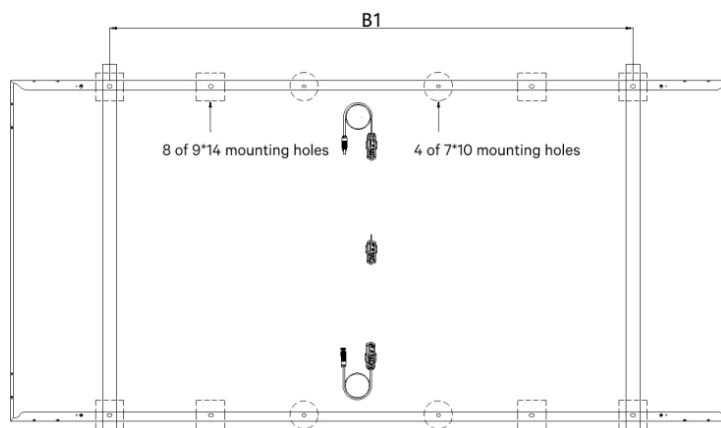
Método de fixação com parafusos (8 orifícios de montagem - 4 instalação externa)
